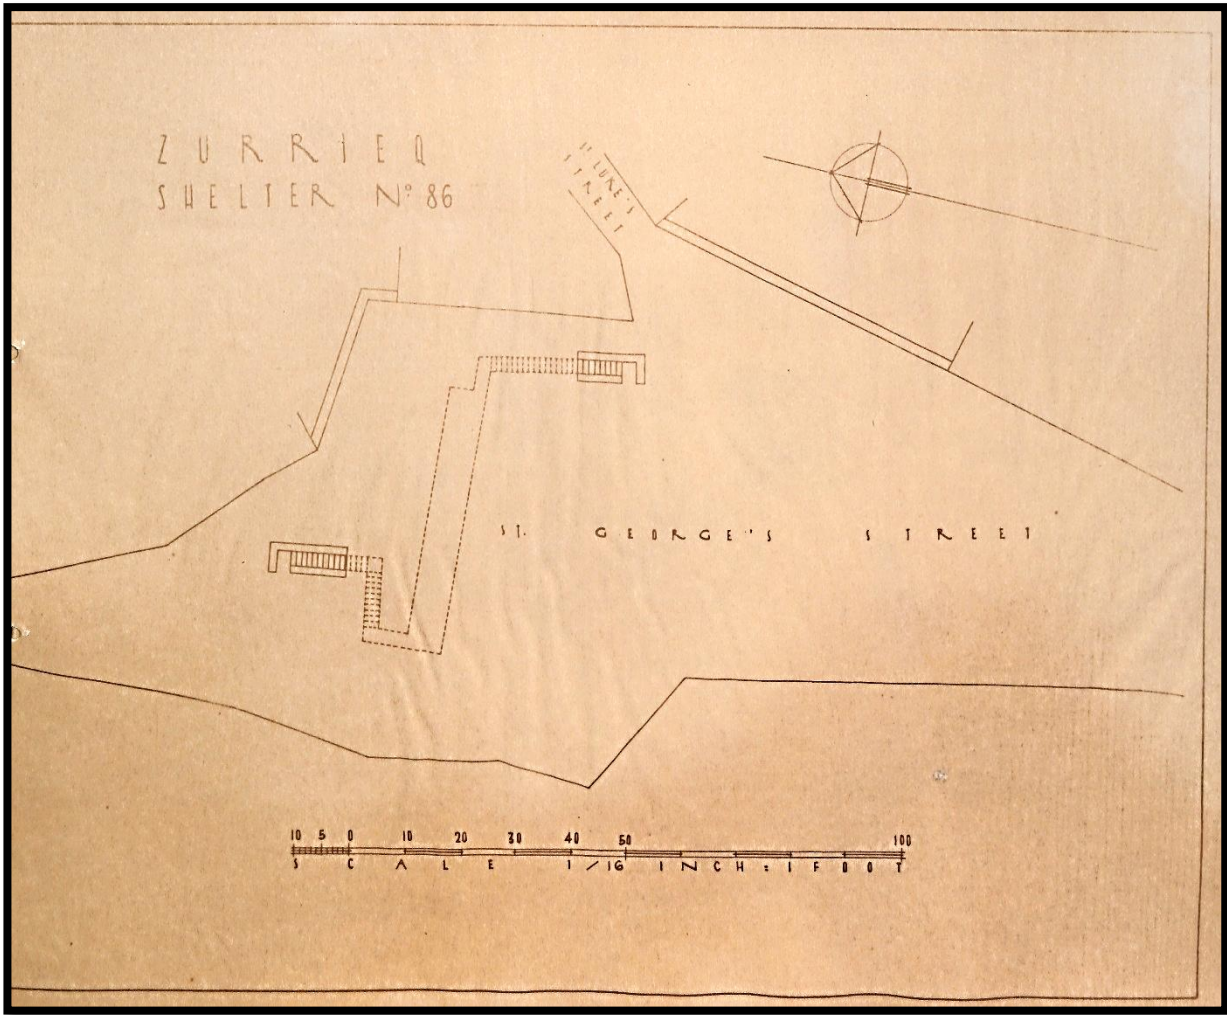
Planta do Abrigo nº86 "St. George's Street – St. Luke's Street."
